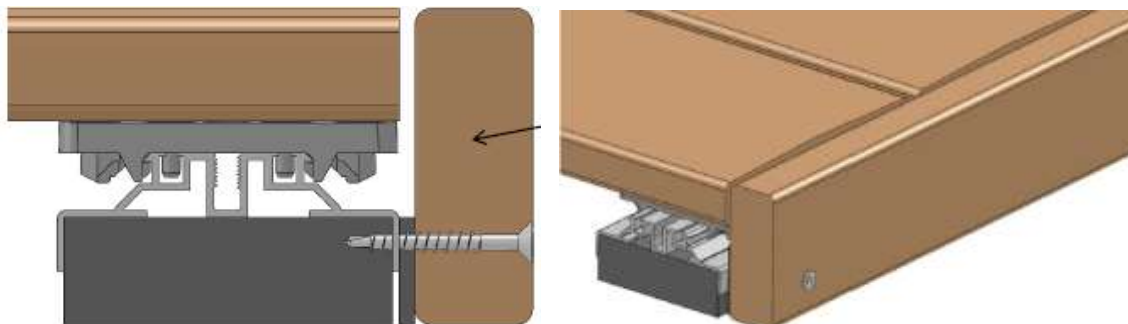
e 12: in alto. Sezione e vista relative alla posa a vista di elementi perimetrali per sottostruttura ad altezza fissa (foto Grad™)
